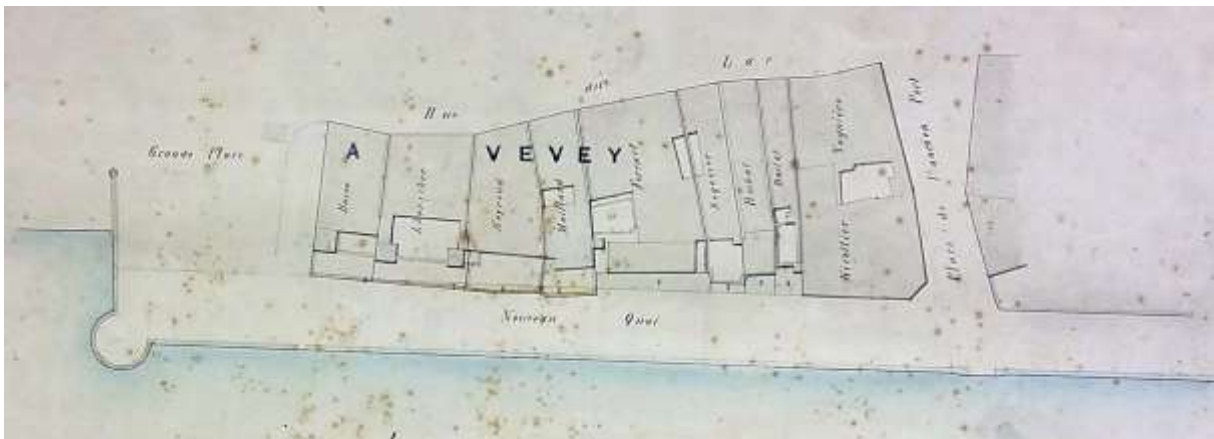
« Plan du quai nouvellement construit entre la place de l'Ancien-Port et la Grande Place », Jules Pallandat, commissaire arpenteur, 12.3.1876 (AV). Aujourd'hui quai Vincent-Perdonnet.
